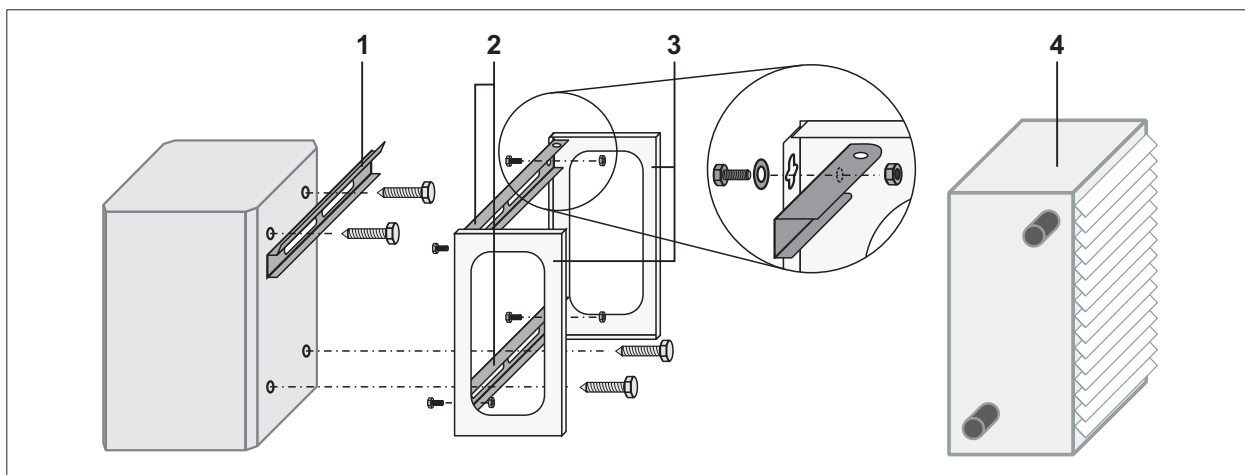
Монтаж воздухонагревателя к бетонной балке с помощью набора для крепления
